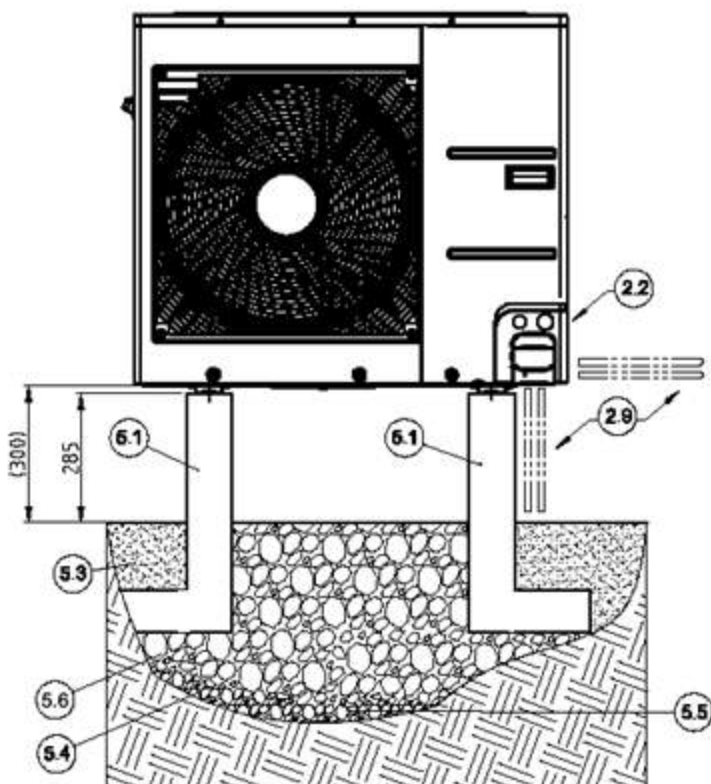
Plan de fondation LAW ..IMR / ITR avec lit de gravier
